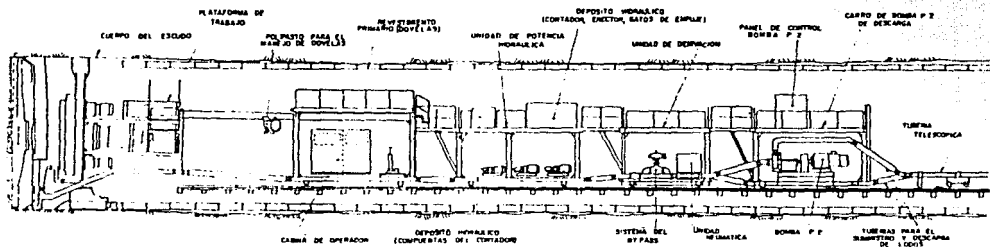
TREN DE EQUIPO DEL ESCUDO CORTADOR
